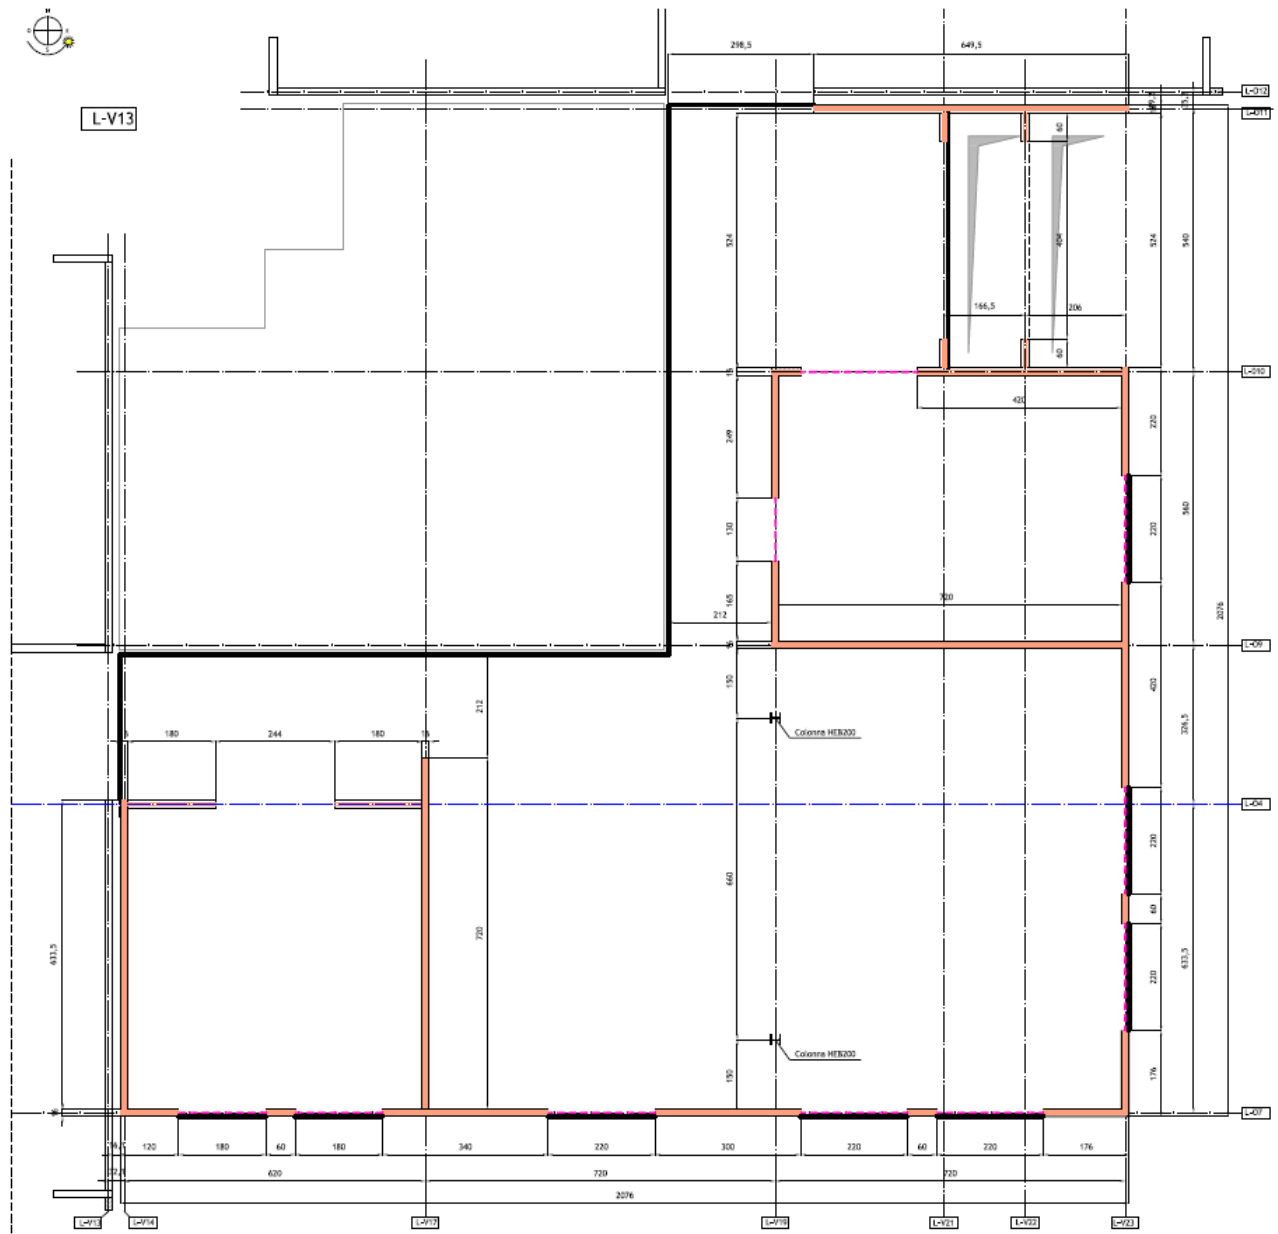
US 02-L planimetria piano primo porzione in X-lam
